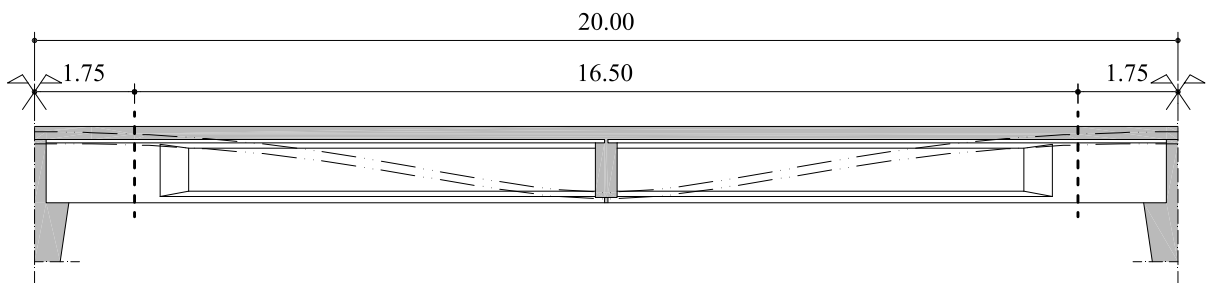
Elevation de la travée III ; emplacement des coupes transversales
